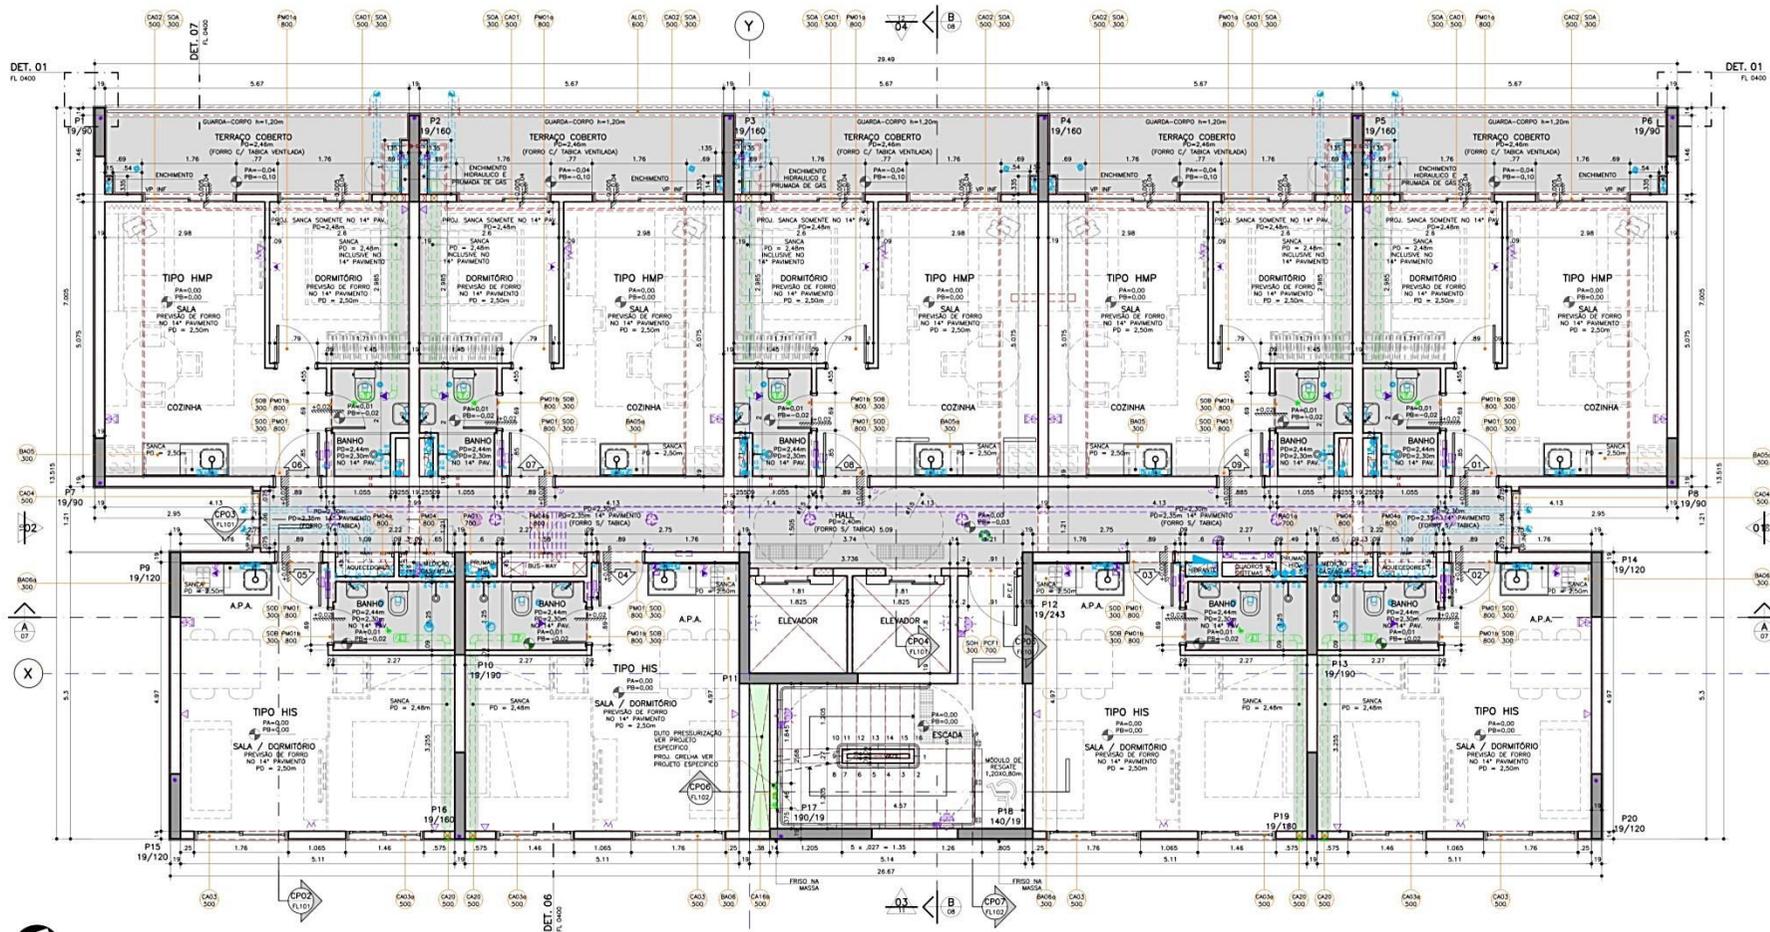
Planta do 1º pavimento – 4 unidades P.N.E. – 26m<sup>2</sup>
